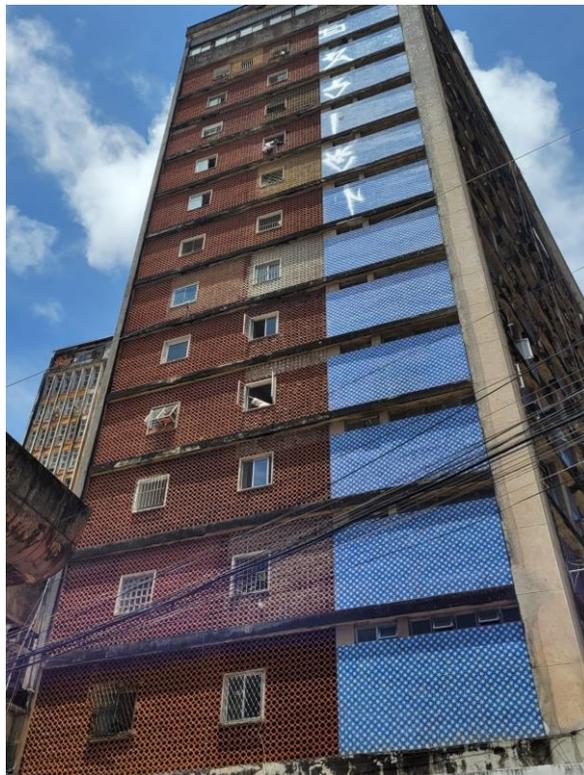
Edifício Santa Rita - Fachada com pano vazado.
